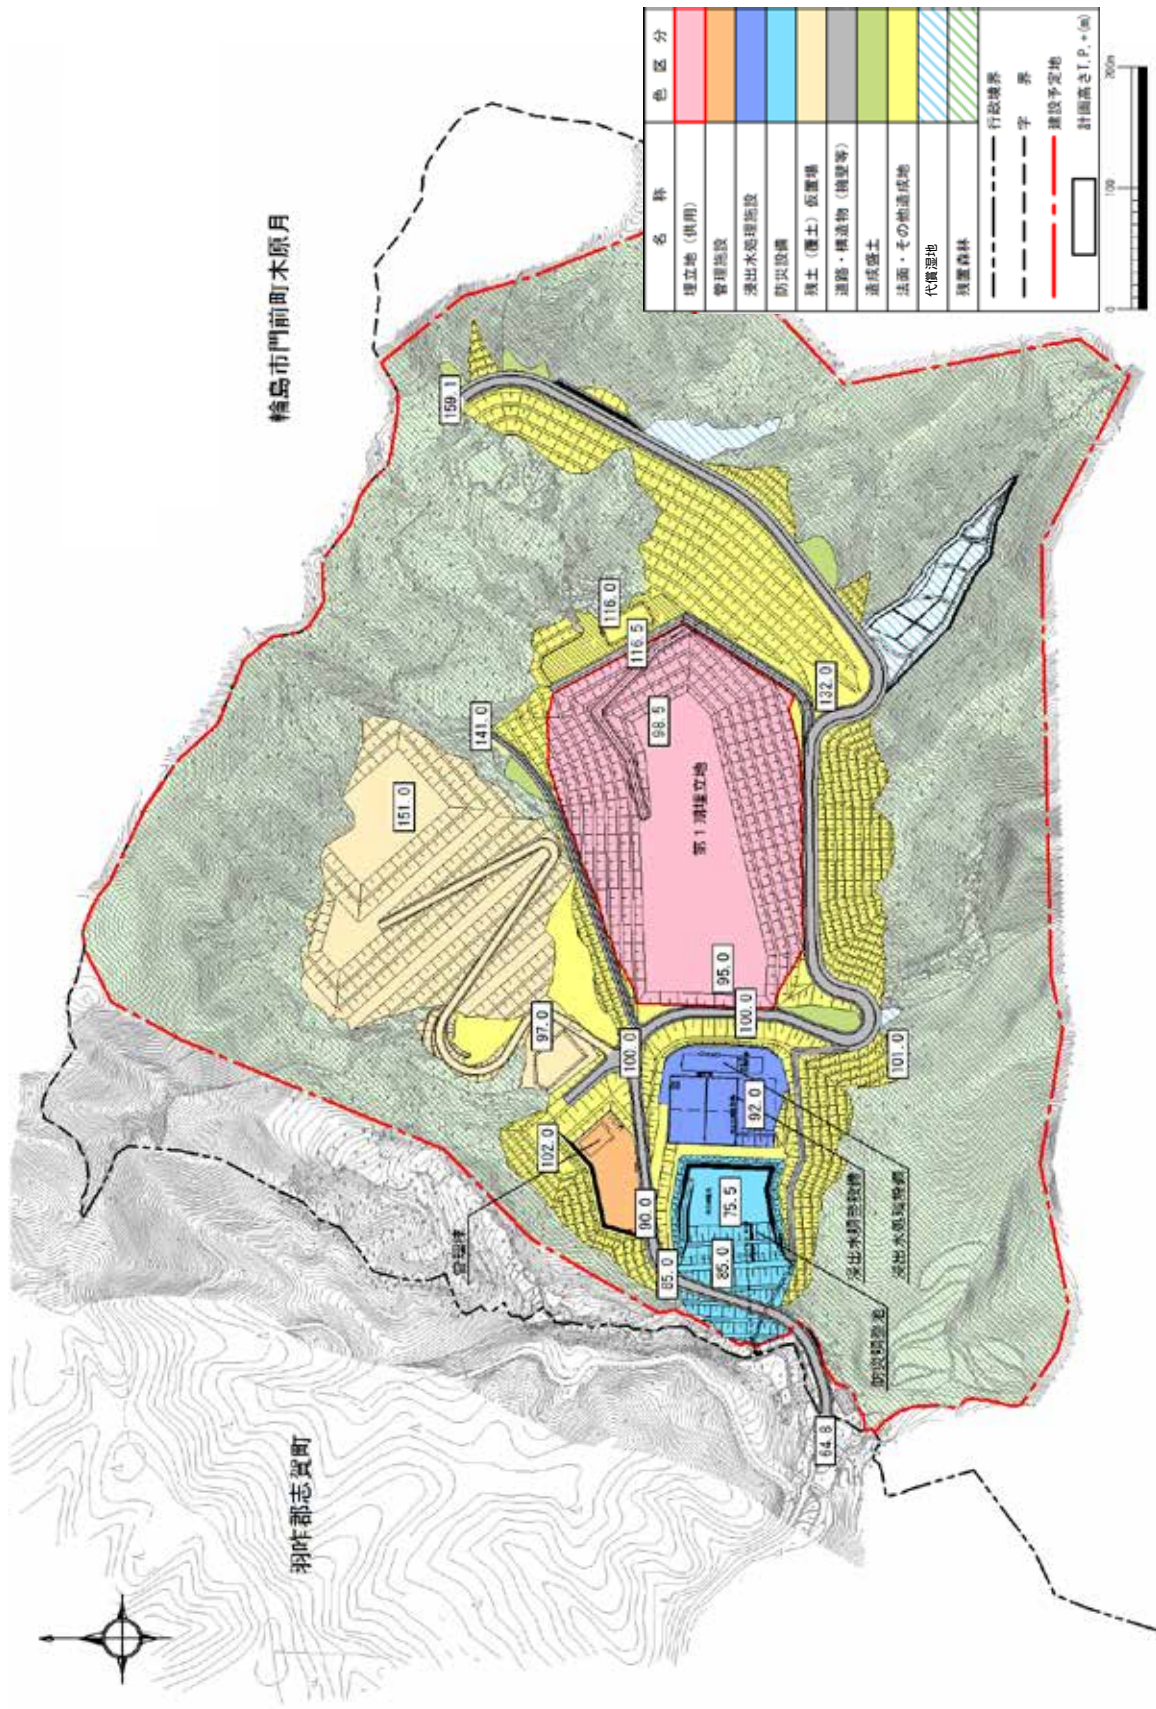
造成・施設配置計画平面図（第 1 期工事完了後）
